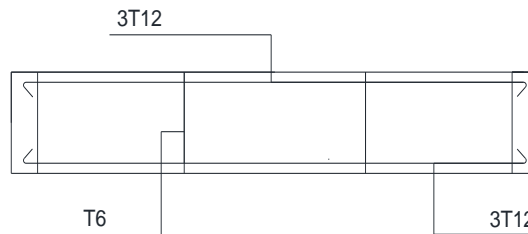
Coupe longitudinale d'une poutre noyée secondaire 15x20cm (plan régulier)
